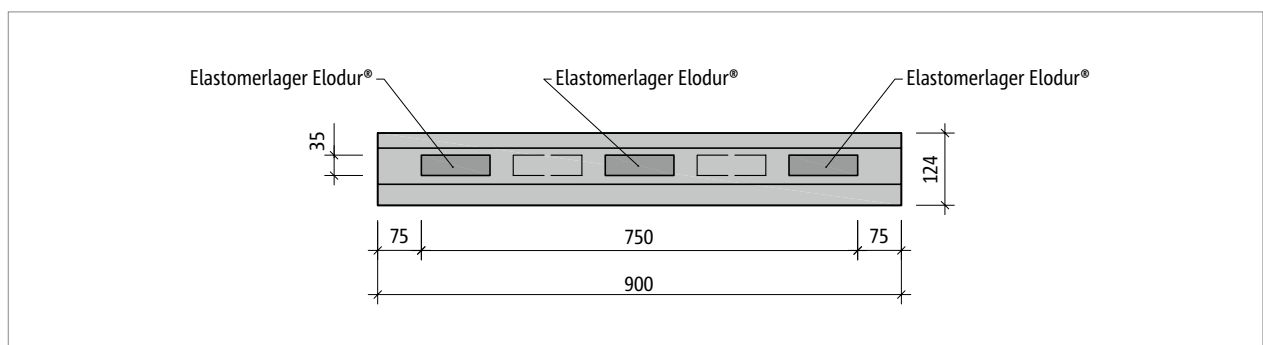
Schöck Tronsole® Typ F: Grundriss
